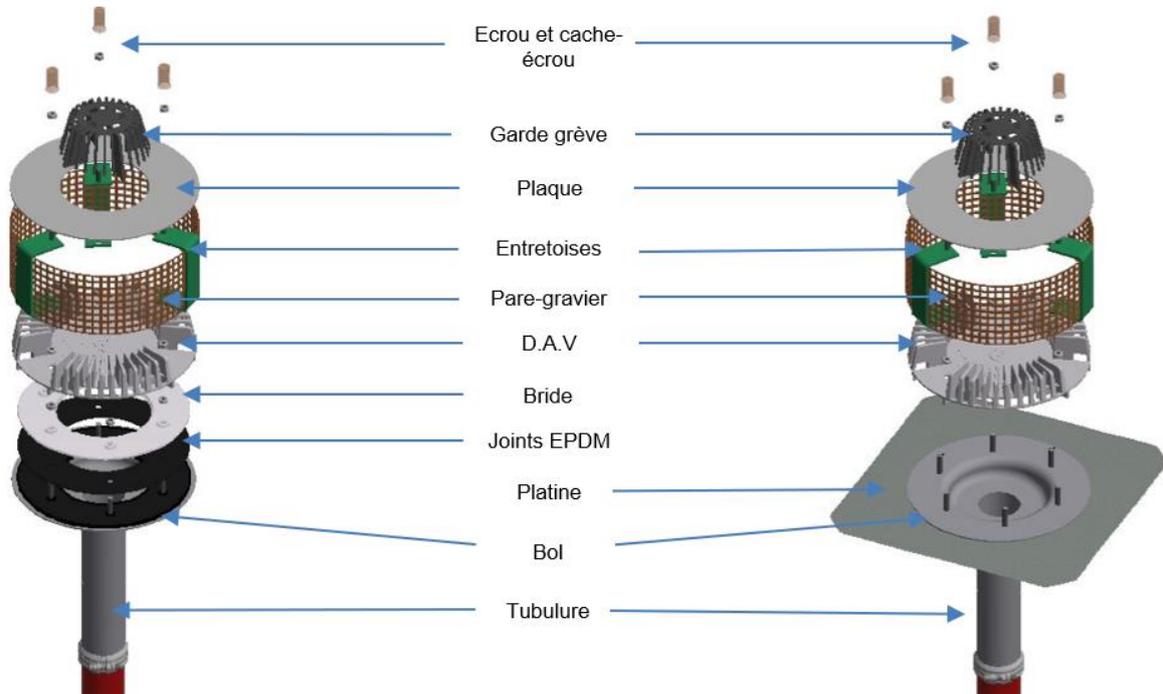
Mise en place du « kit pour toiture végétalisée » sur une naissance à bride (à gauche) et sur une naissance à platine ou à souder (à droite)
